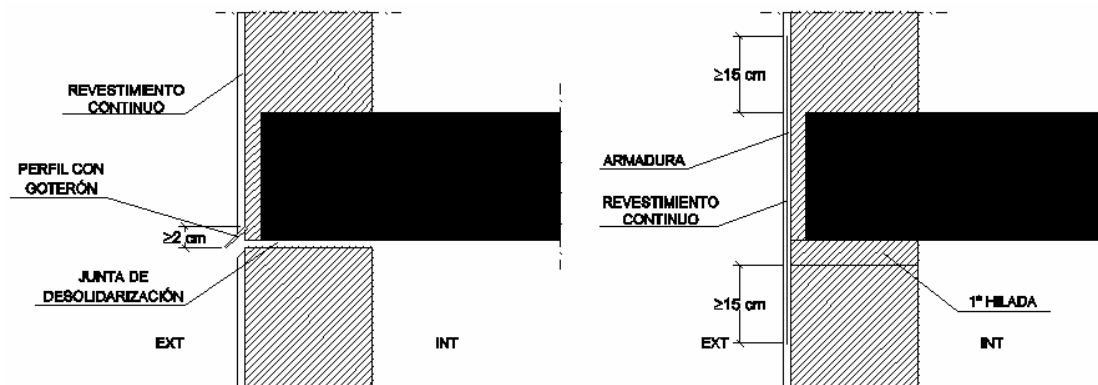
Ejemplos de encuentros de la fachada con los forjados
